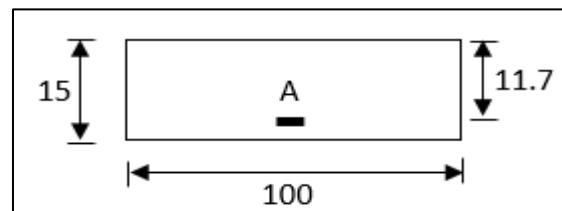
Section du calcul d'une dalle pleine en travée sens y-y
